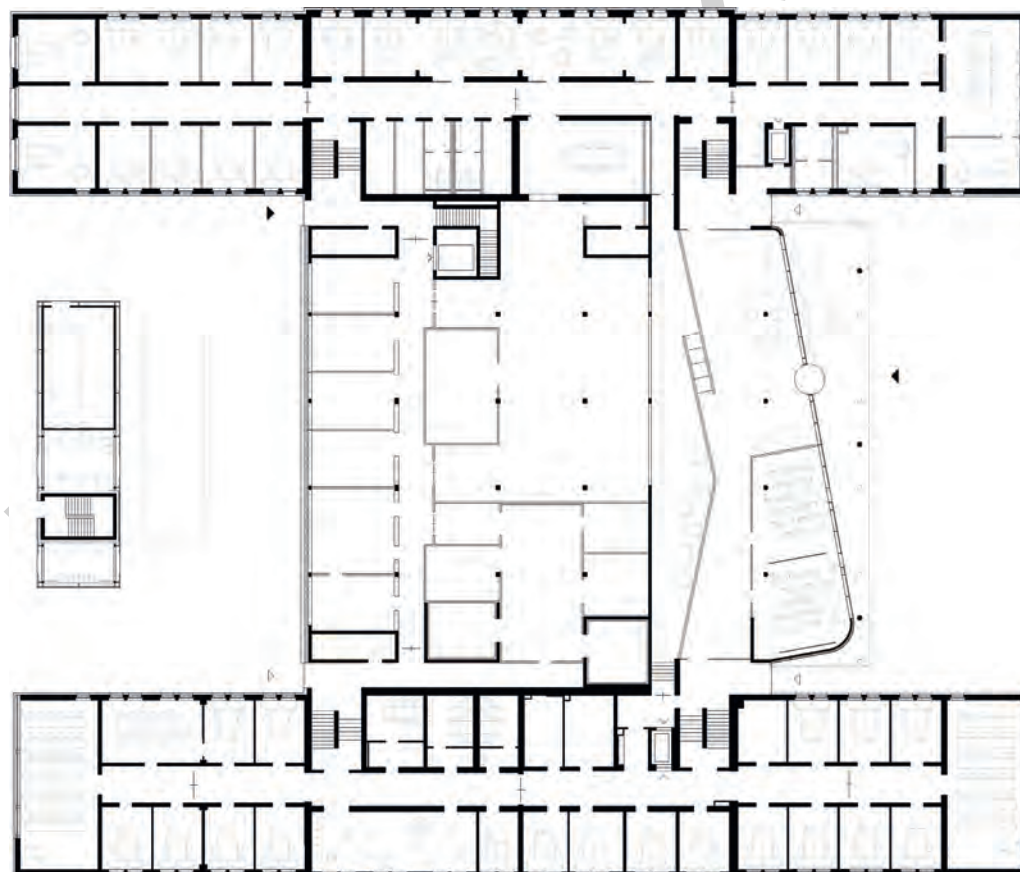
Grundriss Erdgeschoss (Grafiken 2 und 3: Nickl & Partner Architekten AG)
